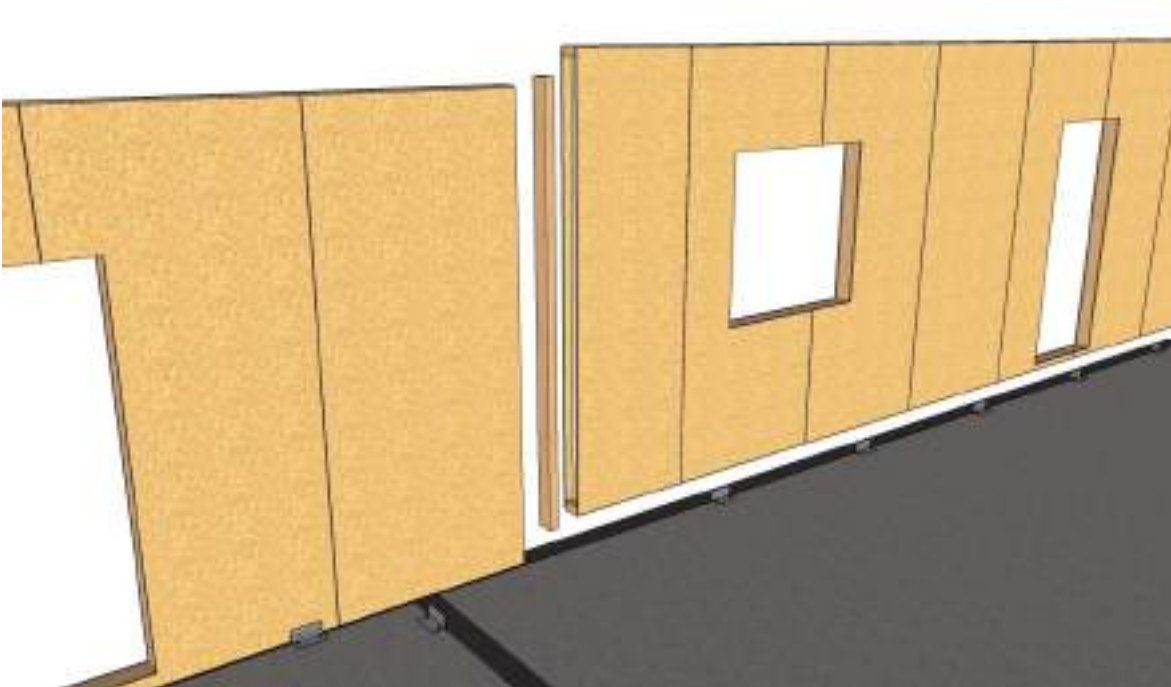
Insertion d'un montant de jonction entre panneaux de mur structurel LogiWall / Couturage au droit des plaques de parement intérieur et extérieur
